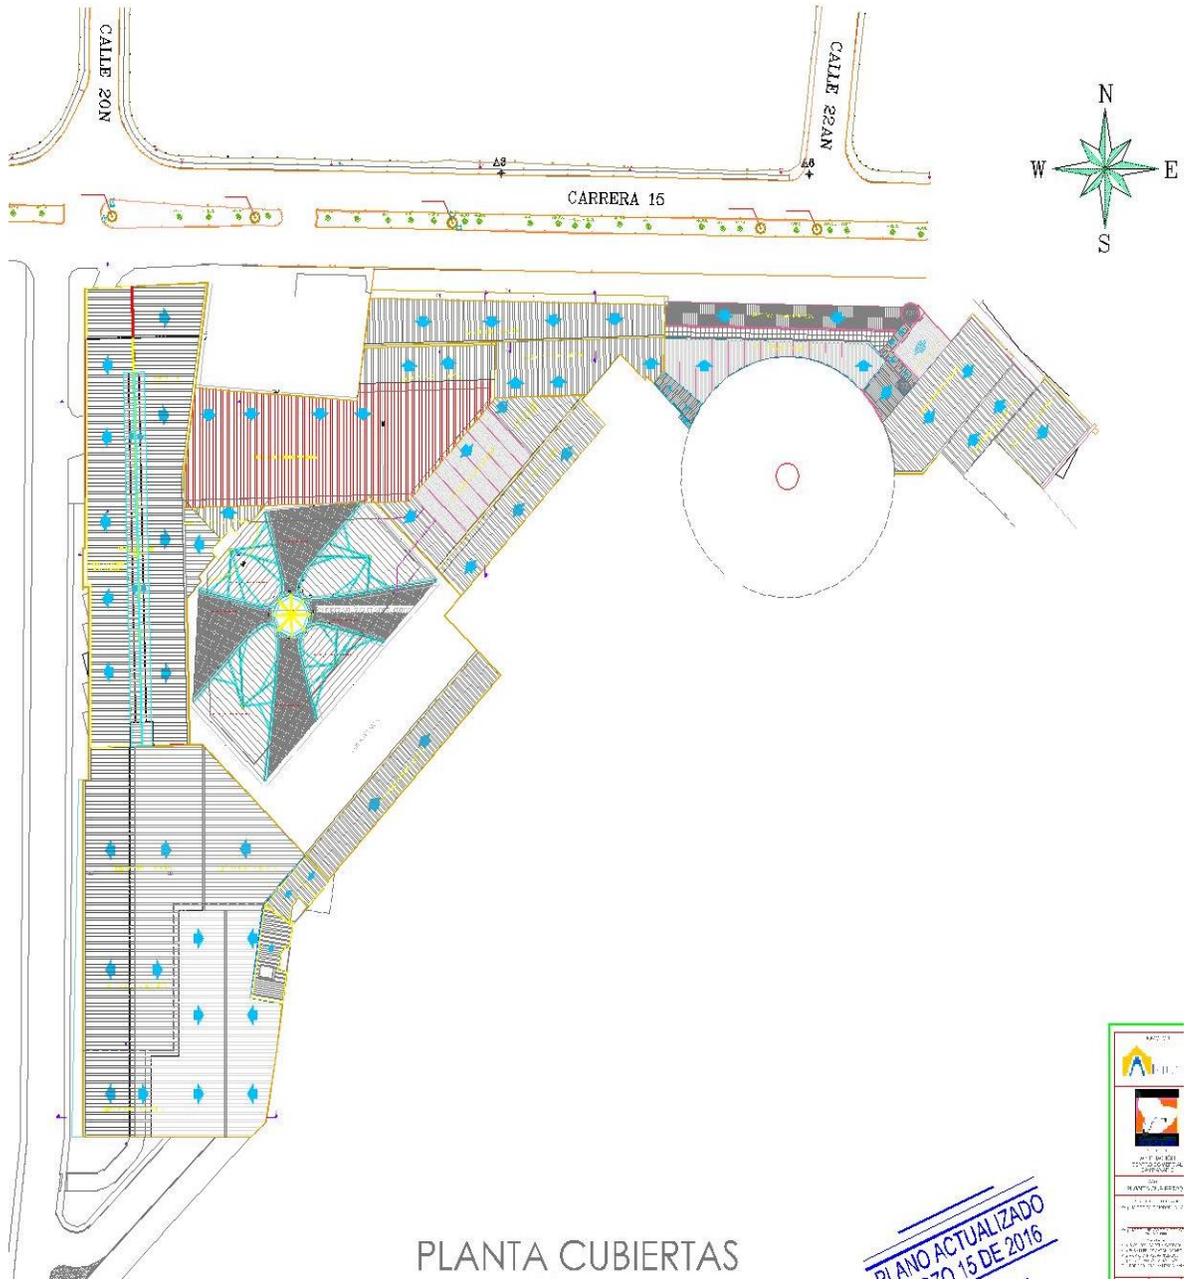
Planta arquitectónica, Cubiertas. (Fuente: Diseño arquitectónico ARINSA)
